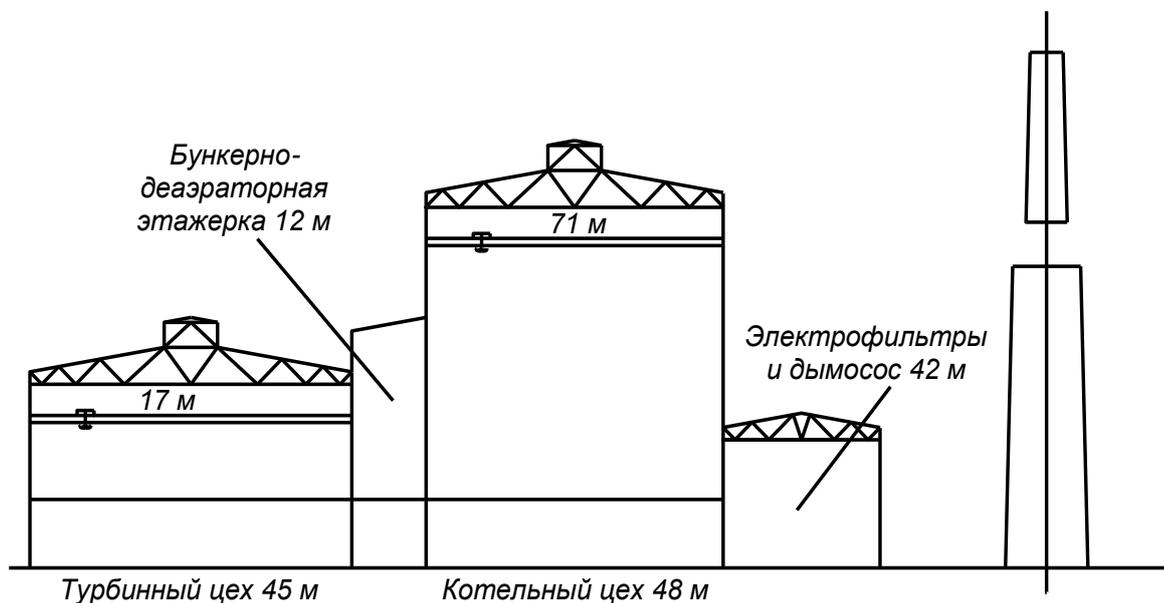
Компоновка главного корпуса блочной ТЭЦ – 175 МВт
